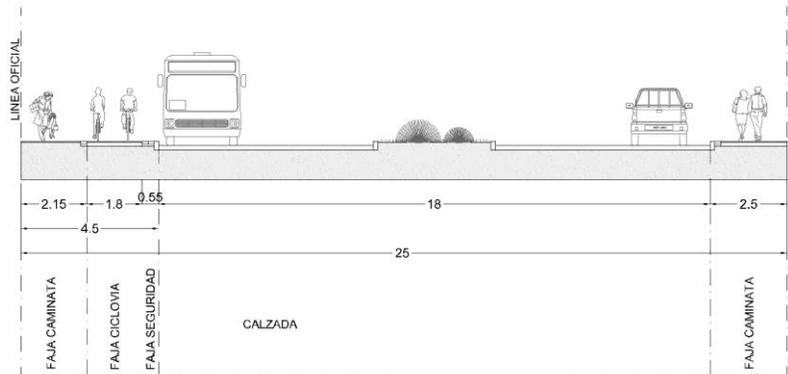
Perfil Tipo Pedro de Valdivia entre Javiera Carrera y Chivilcán
